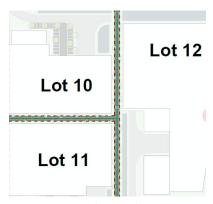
Zoom du plan de paysage – Espace privé réglementé
